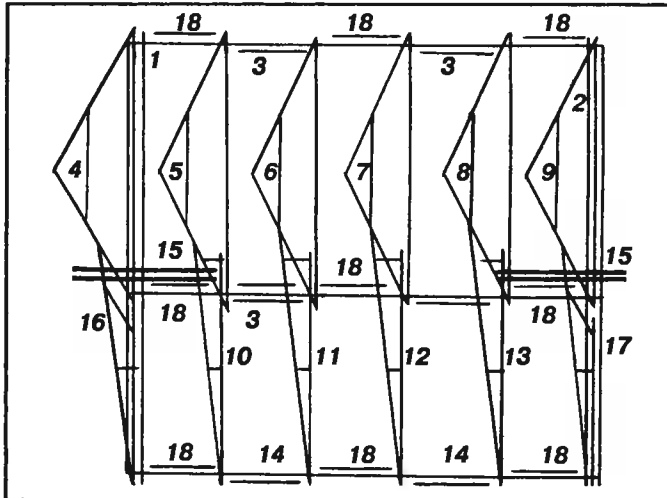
Порядок сборки каркаса крыши: 1, 2 – бруски для крепления фронтонов; 3 – бруски для крепления ферм комнаты; 4...9 – фермы комнаты; 10...13 – фермы веранды; 14 – бруски для крепления ферм веранды; 15 – обрешетка для крепления карниза; 16, 17 – фронтоны веранды; 18 – бруски между фермами
